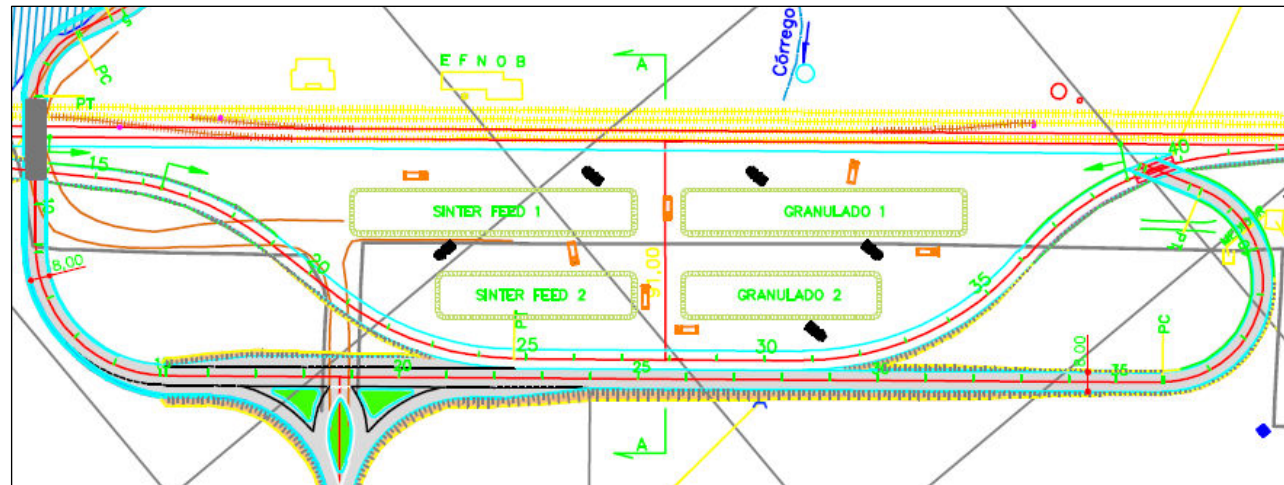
Planta da disposição das pilhas em pátio de produtos
